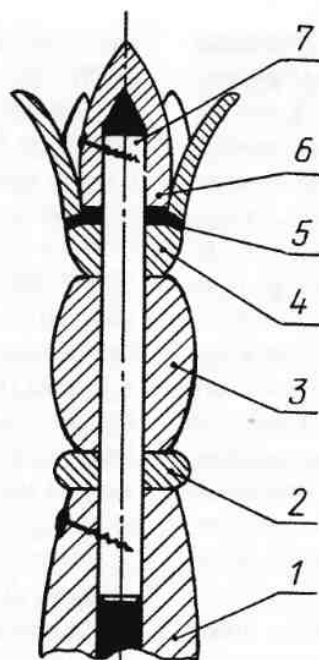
Конструкция фиалы столбика: 1 — верхняя часть корпуса столбика; 2 — кольцо из осины; 3 — резной бочонок из ольхи; 4 — чаша из осины с шестью лепестками; 5 — отверстия для стока воды; 6 — резной колпак из ольхи; 7 — соединительный шток (шип)
